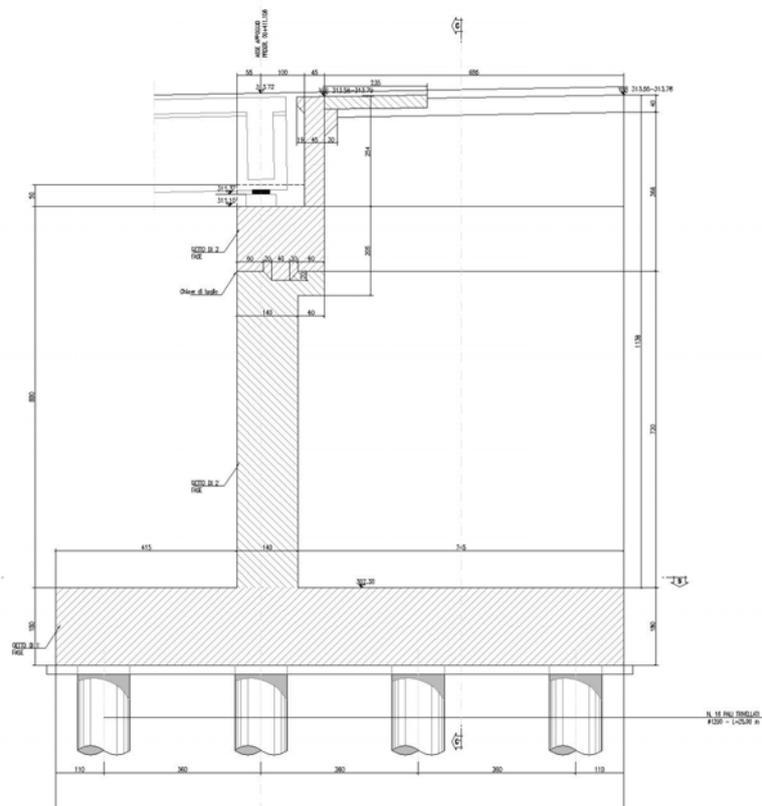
Sezione longitudinale della spalla B.
